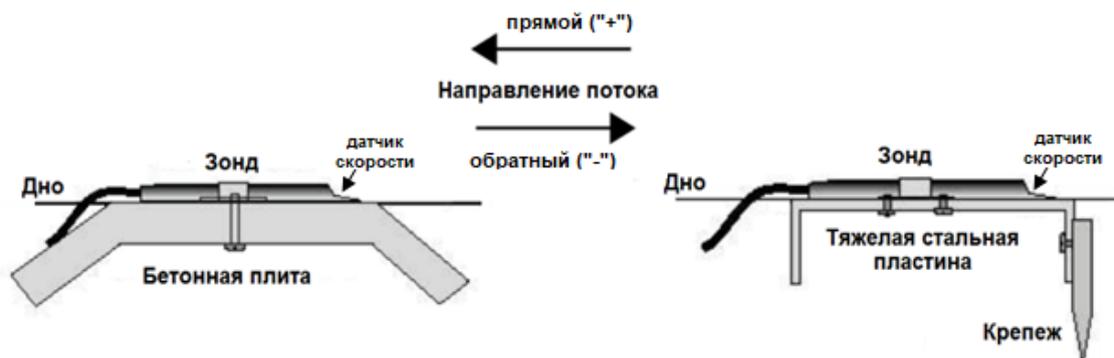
Монтаж зонда расходомера в открытом канале / русле
